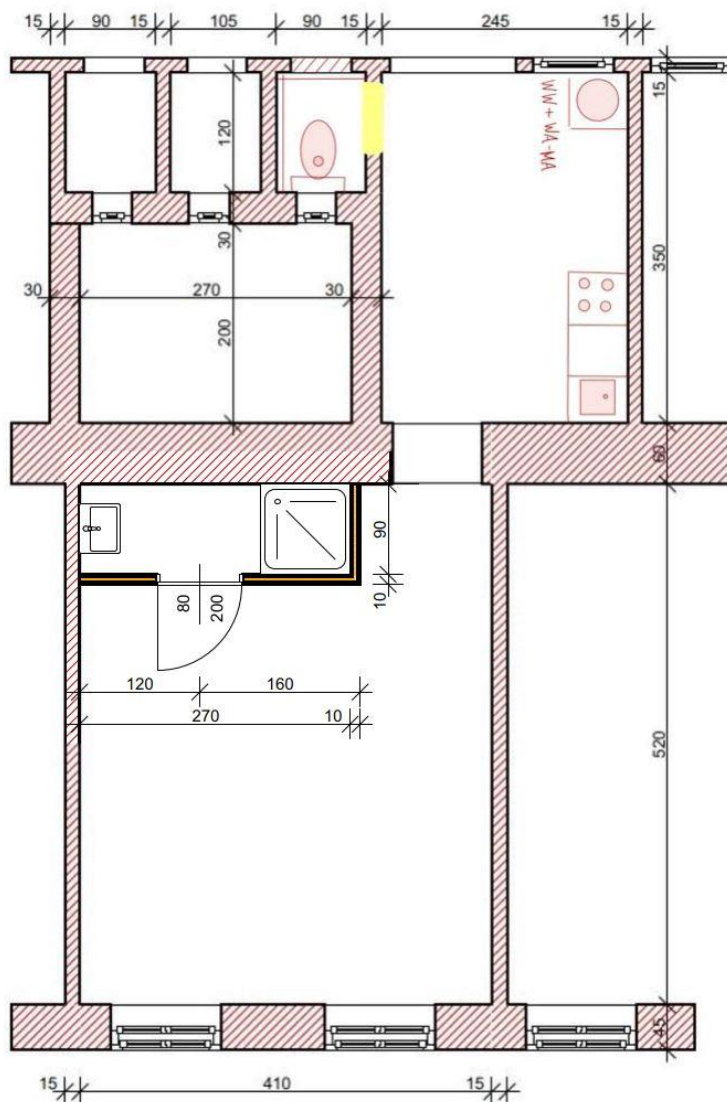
Grundriss mit Bad- und Kücheneinbau
